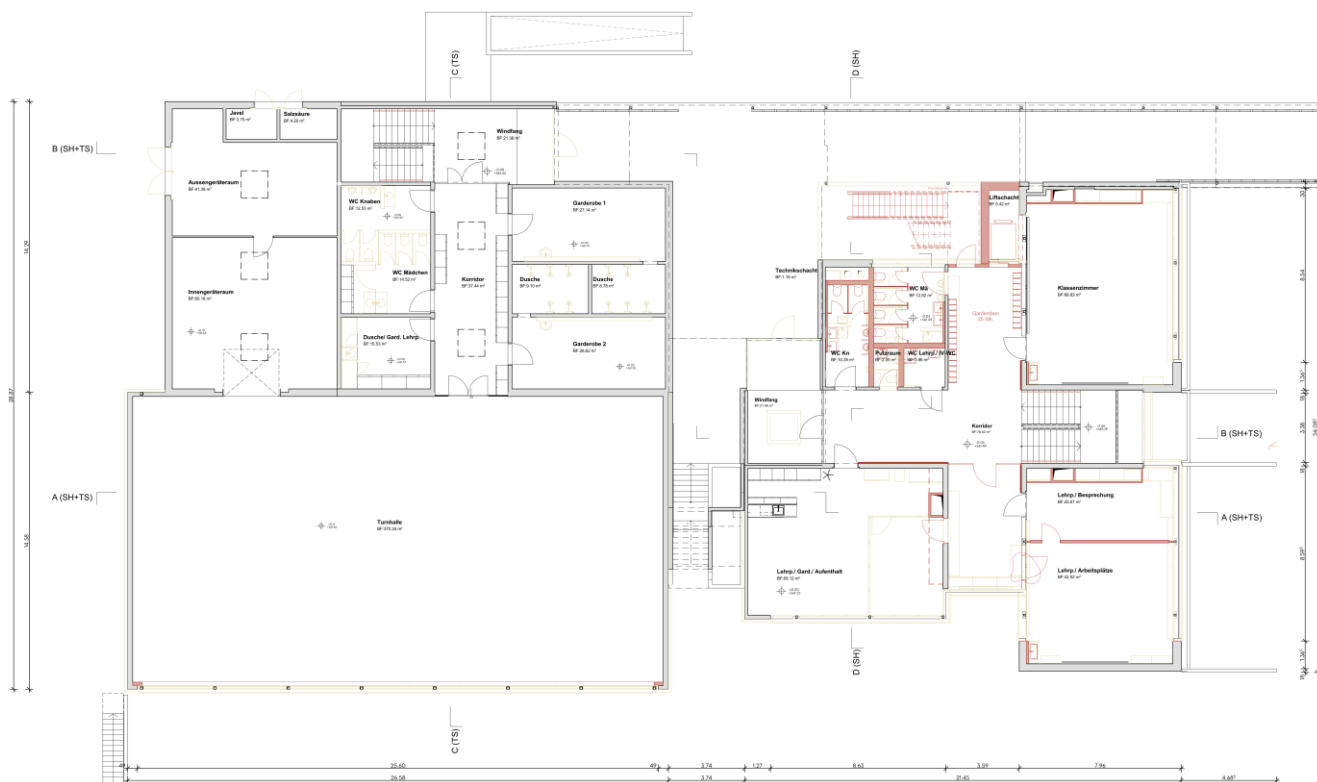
Grundriss Erdgeschoss, Gebäude 1 (links) und 2 (rechts)
